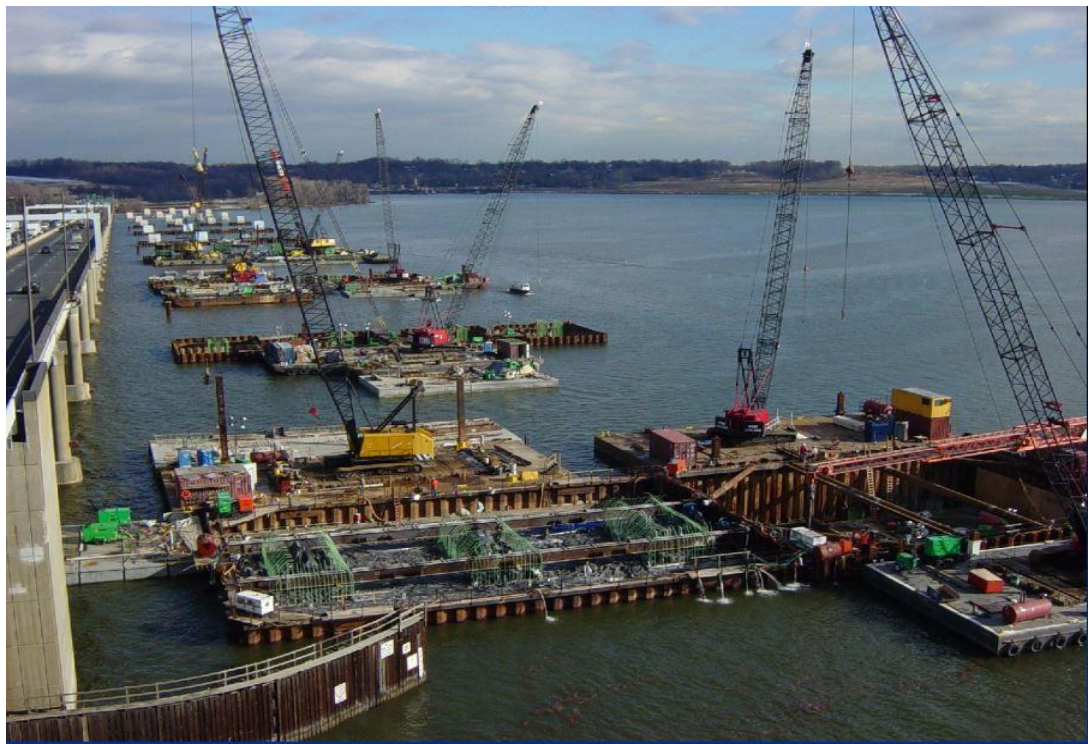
43 Woodrow Wilson Memorial Bridge 河中基礎施工
